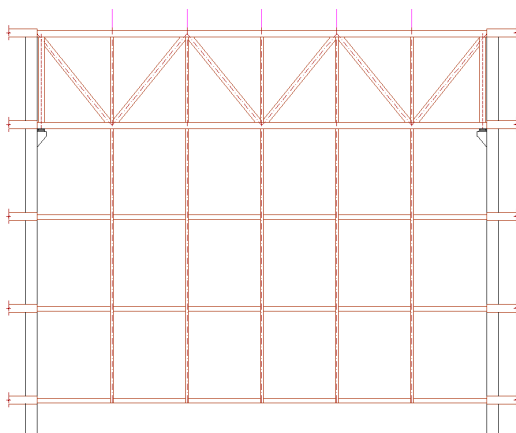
Alzado de la pasarela con la viga triangulada en la parte superior.
